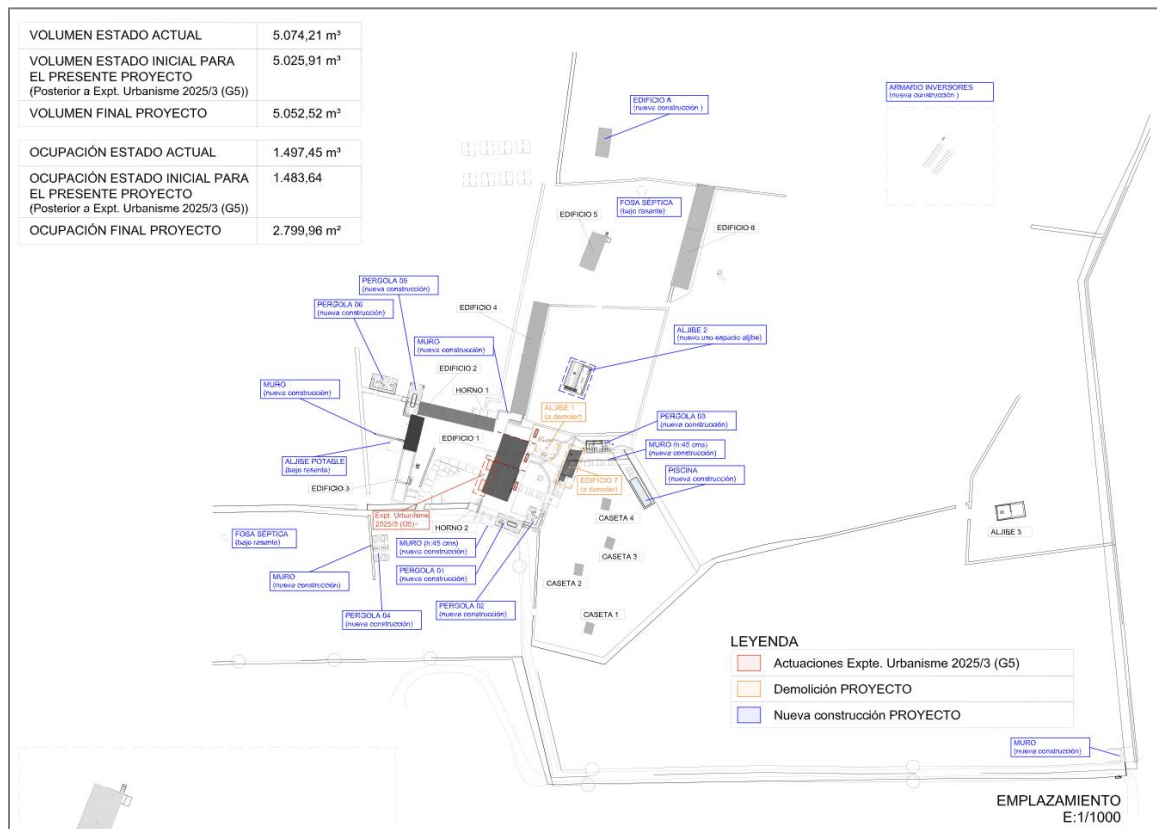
EMPLAZAMIENTO. ÁMBITO DEL PROYECTO. (FUENTE: PLANO SIT 057A. PROYECTO)
